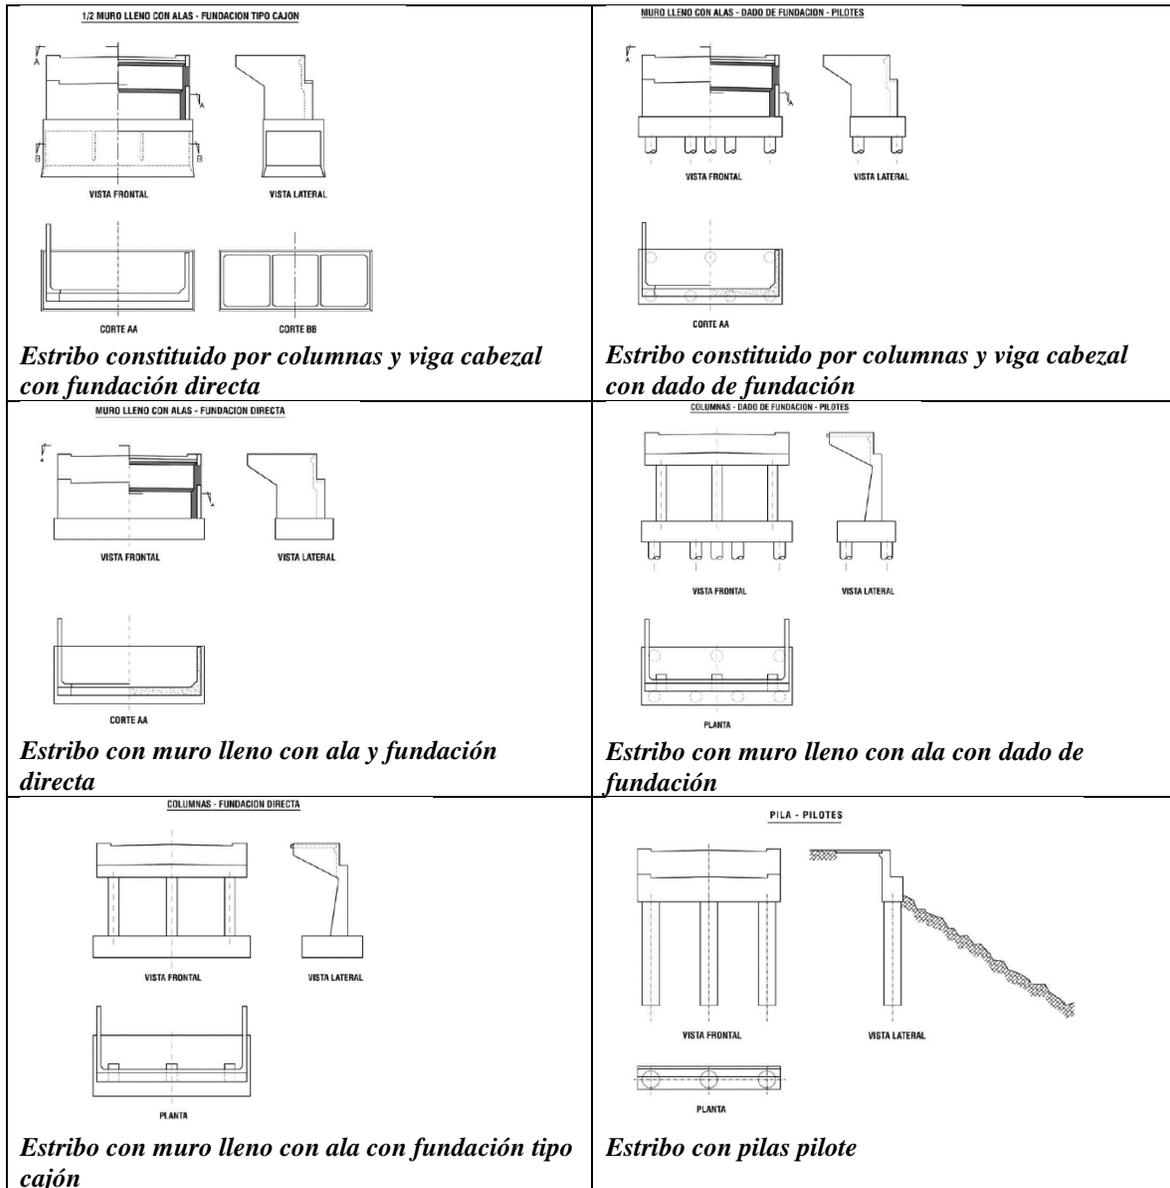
Tipos de estribos según el Manual de Carreteras
